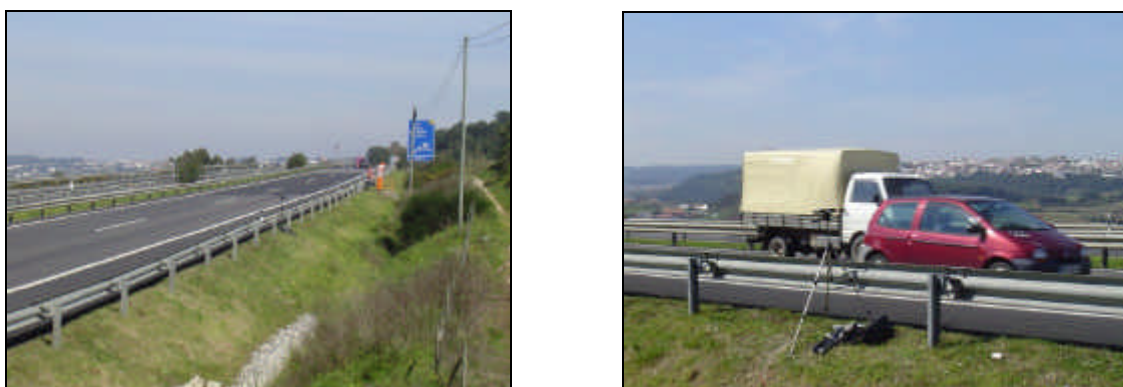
Vista geral e pormenor do ensaio do BB / BMB
